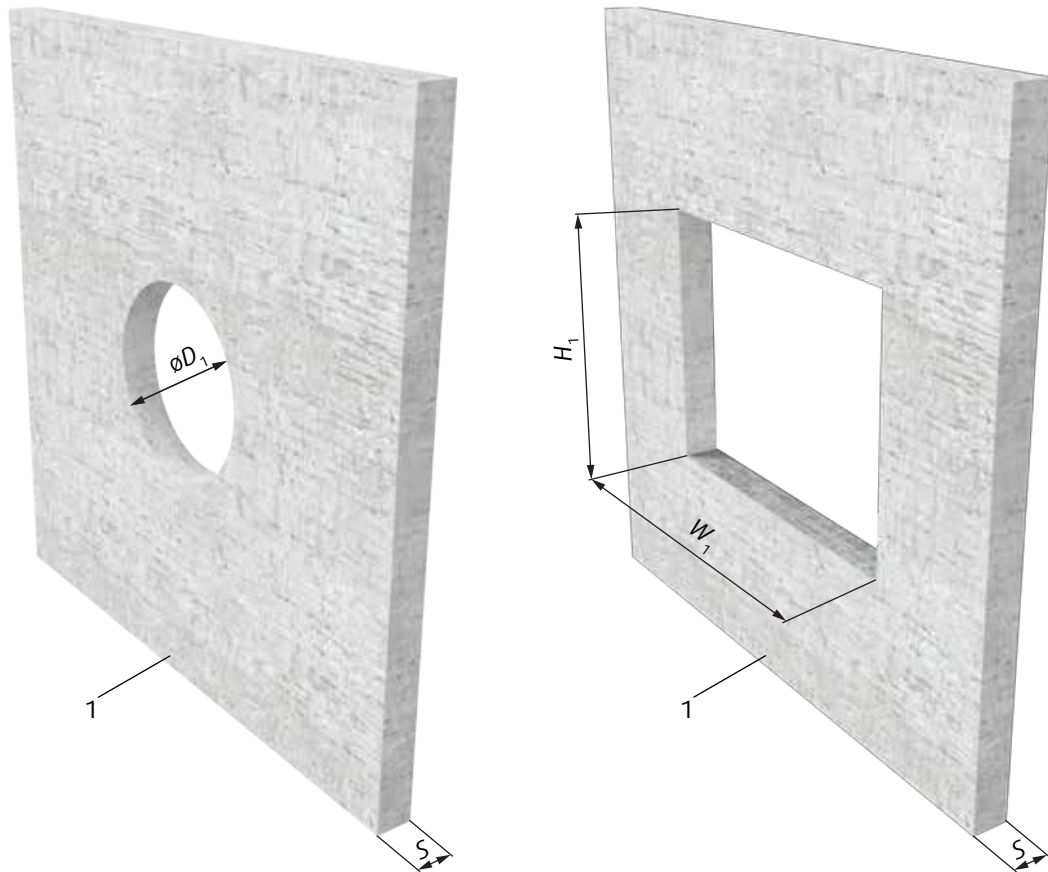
Steenachtige wand/steenachtig plafond met ronde/rechthoekige sparing
